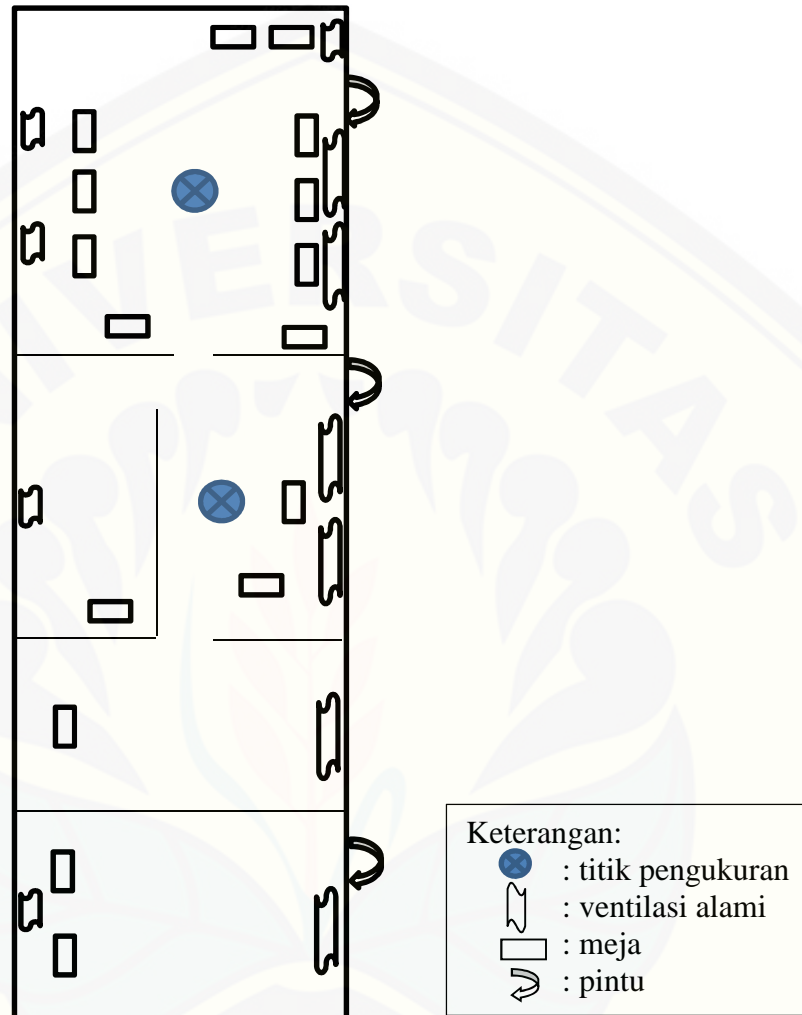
Denah Ruang Kantor Kelurahan Tegal Gede
